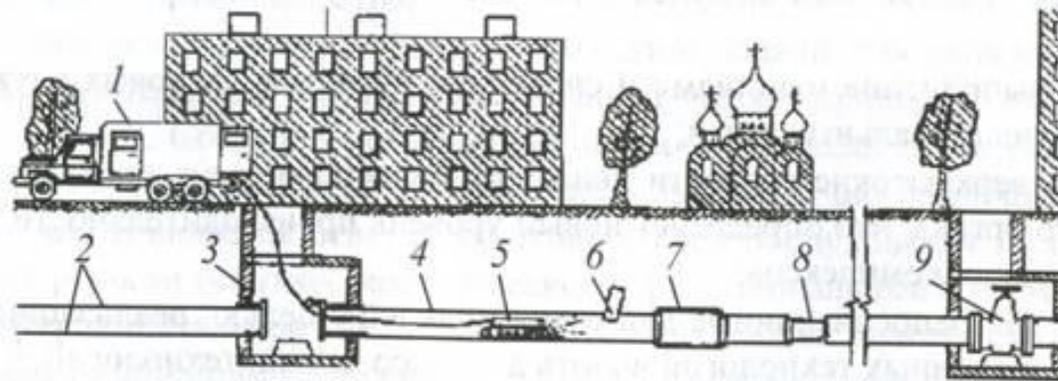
Схема обследования внутреннего состояния подземного трубопровода мобильным роботом:
